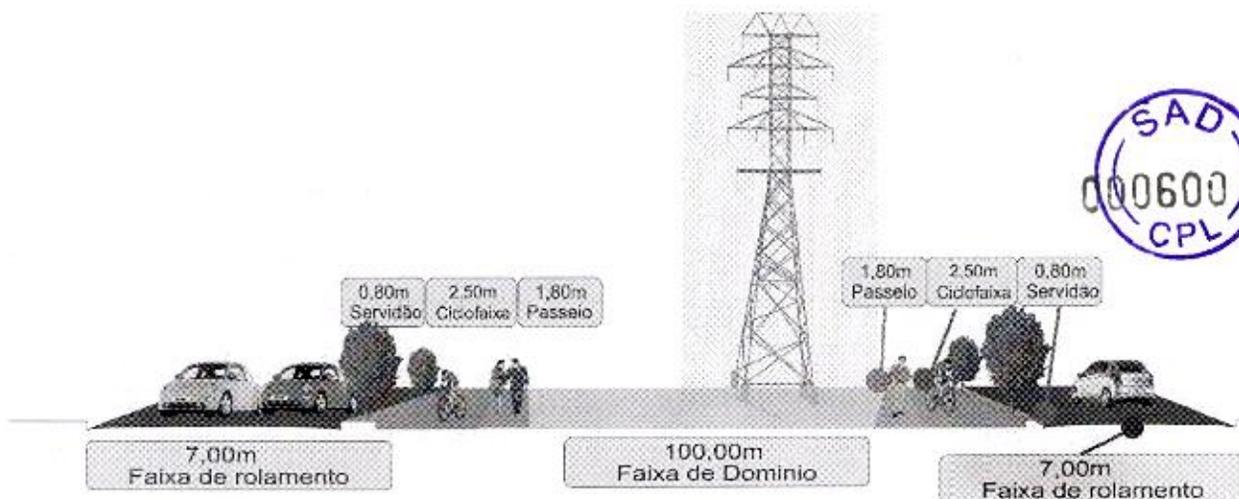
Desenho tipo secção da via ( Murilo Cabral)
